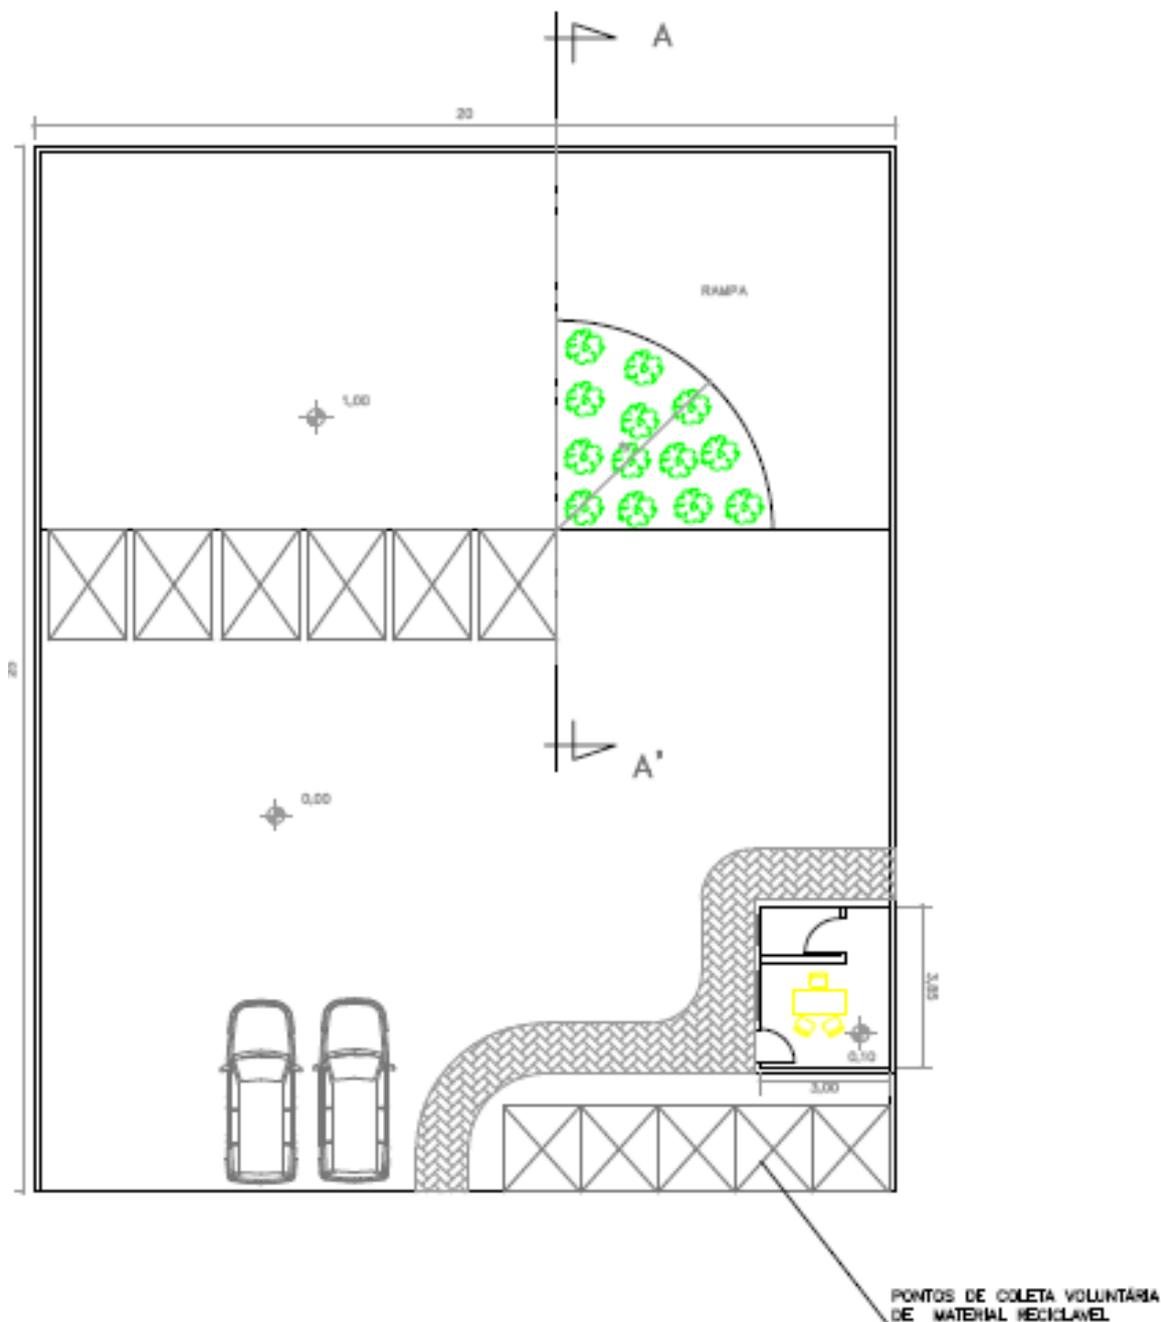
Planta Baixa (sem escala) do projeto de instalação de pontos de entrega voluntária
